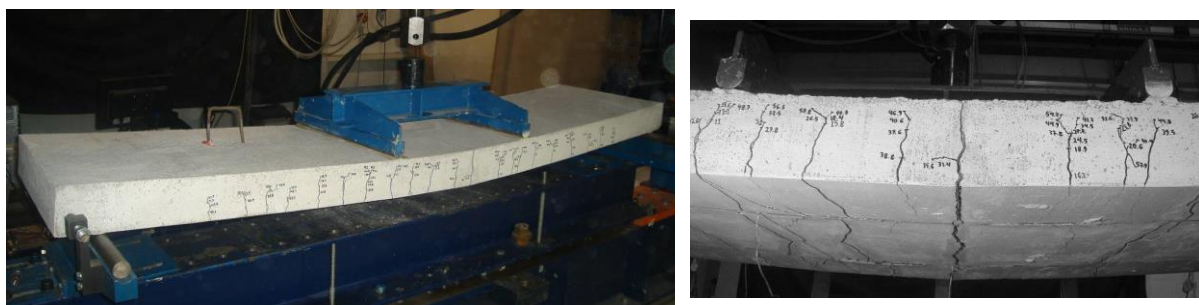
Laje S2L-PC2 após o ensaio à rotura e pormenor do modo de rotura.
